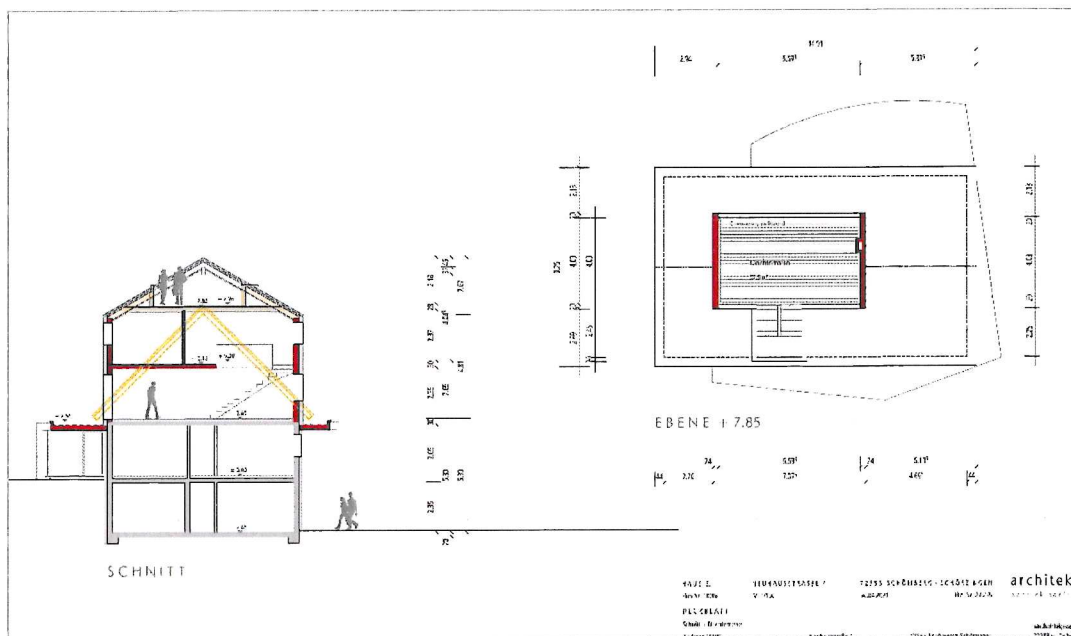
Neuhausstraße 4 – Schnitt und Dachterrasse, 30.04.2021, Architekt Patrick Saffrin
